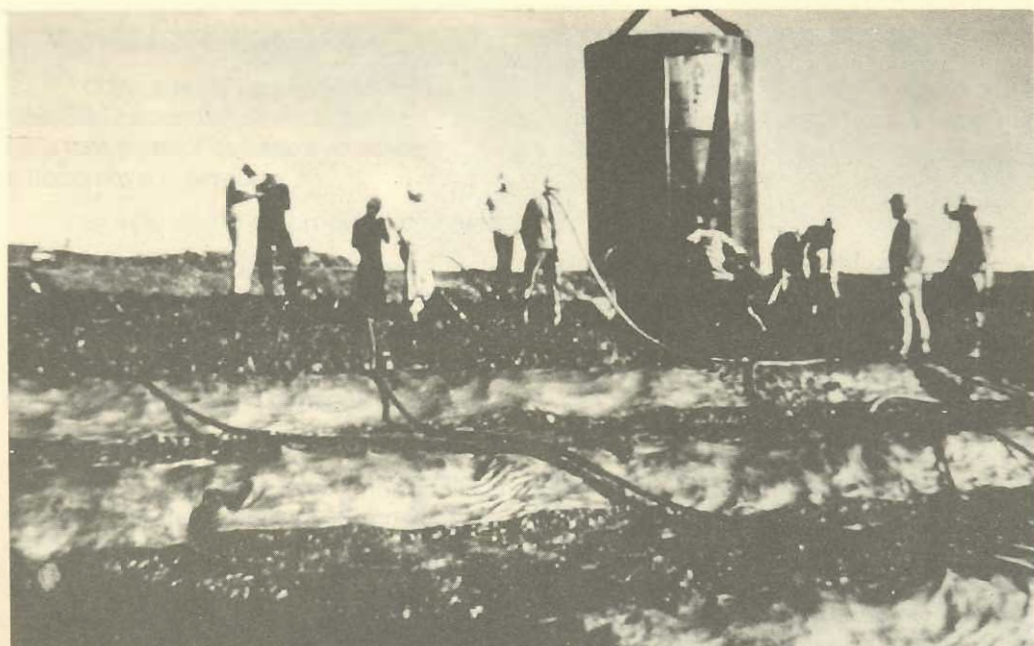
Caçamba de acionamento pneumático, usada para colocação do concreto - Ilha Solteira
